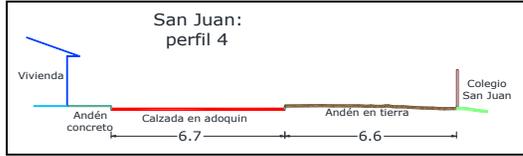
Perfil 4 Vía Local en adoquín en concreto Centro Poblado San Juan
